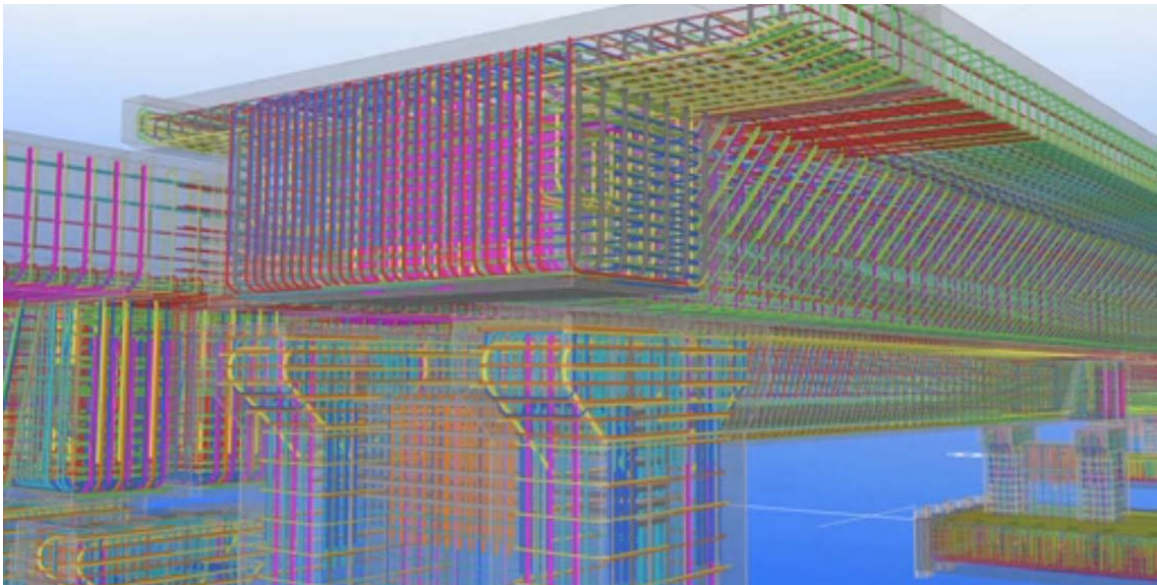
Bagers Plats, Malmö. Här testades överföringen mellan konstruktör och arbetsplats.
